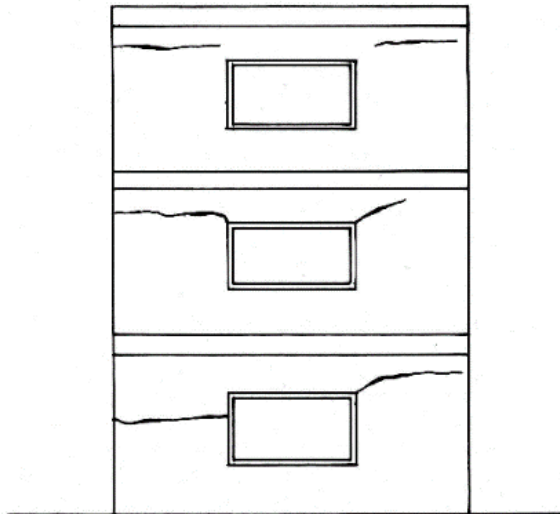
Fissura causada por movimentação higroscópica em fiadas inferiores
